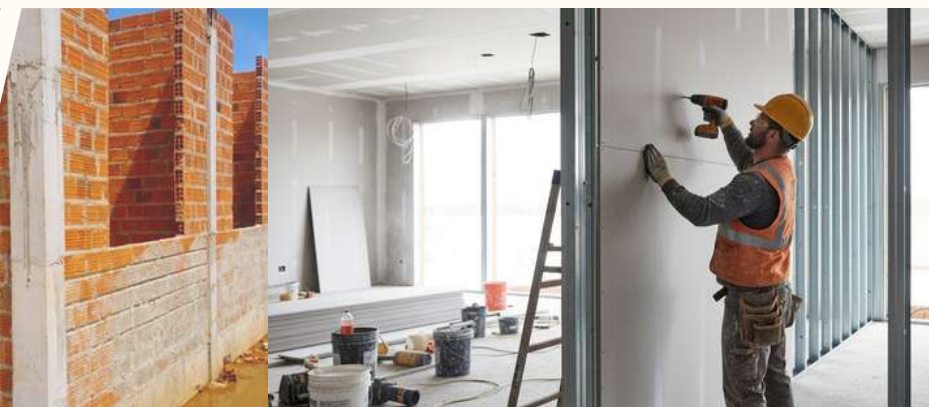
Drywall. Fonte: IA Gemini, 2025.
